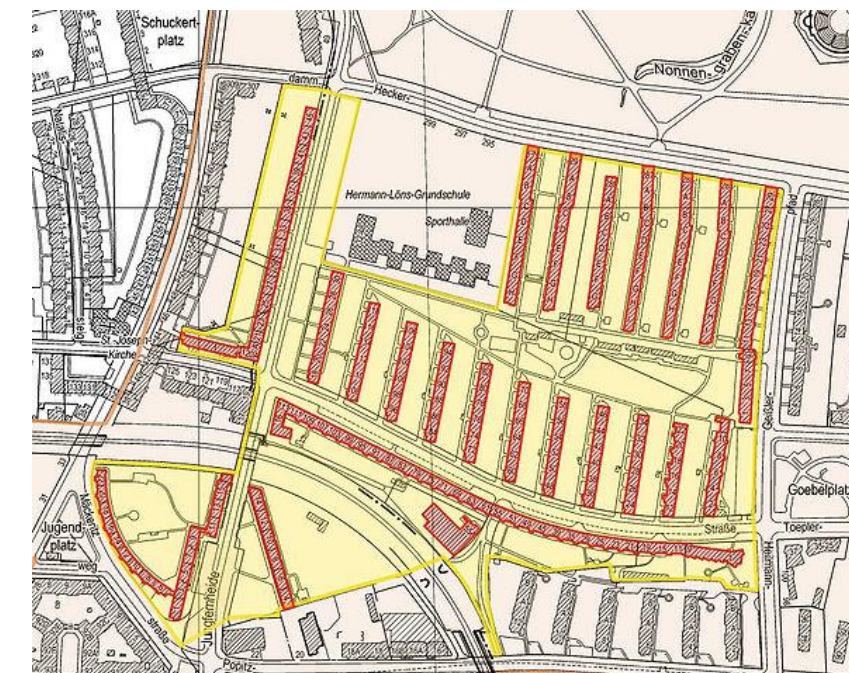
Siemensstadt, bloque de departamentos. Planta de conjunto. Gropius 1931
